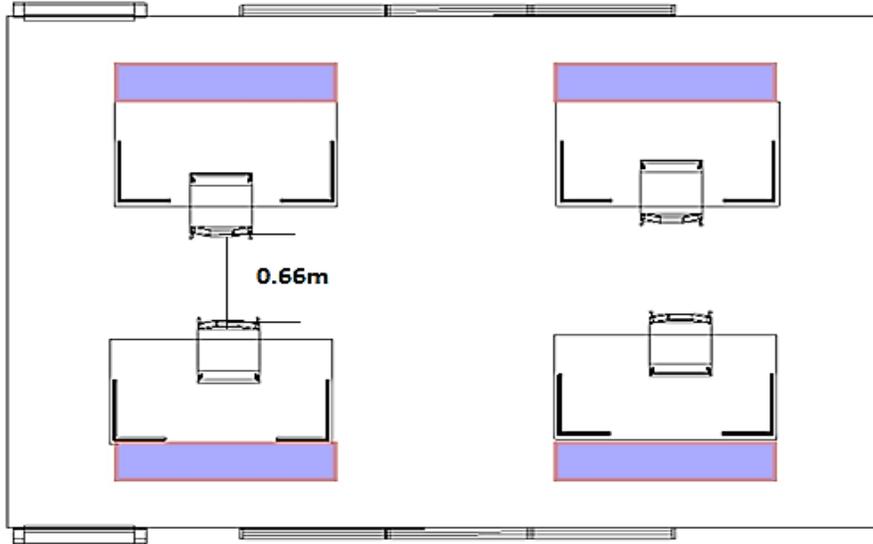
Vista en planta del laboratorio de telemática con las mesas de trabajo desplazadas.
